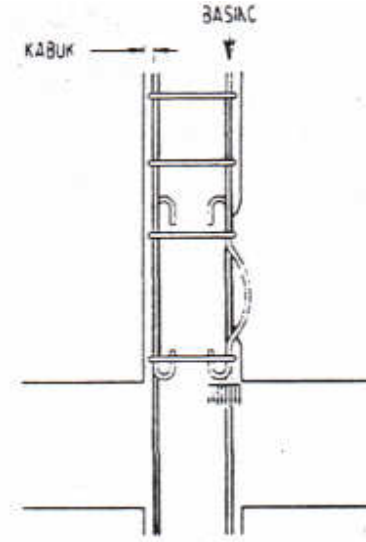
Kancanın betona uyguladığı kuvvetler ve oluşan çatlak.
